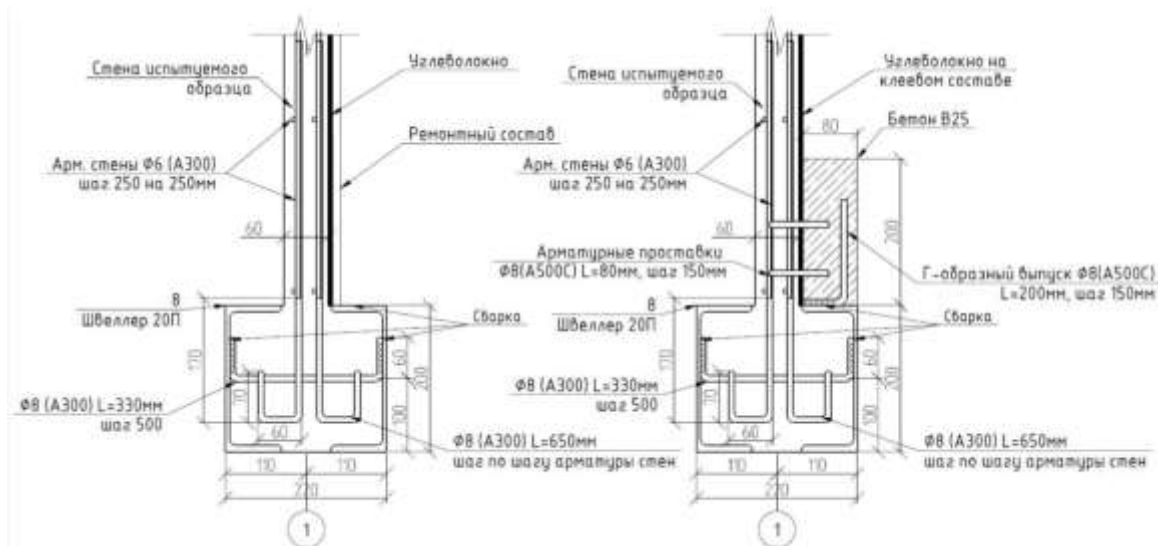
Конструкции основания. Схема анкеровки армирующего материала
